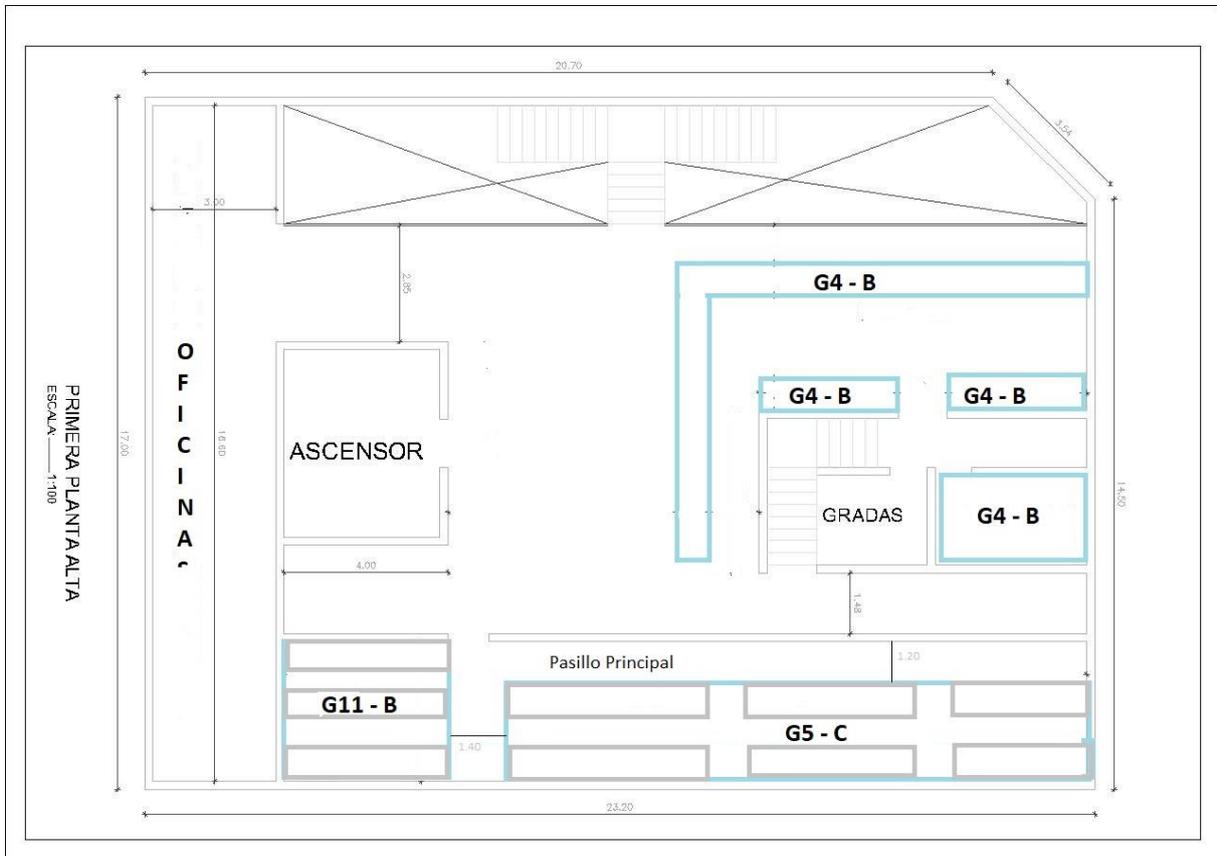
Propuesta de Distribución Primera Planta Alta
